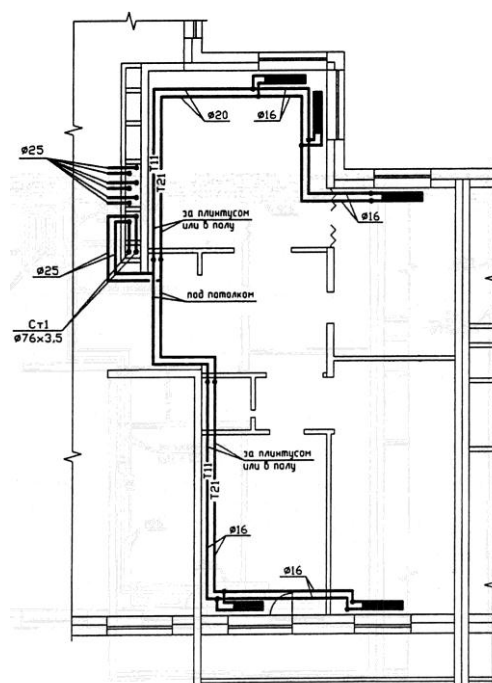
Система отопления с периметральной разводкой теплопроводов по квартире
